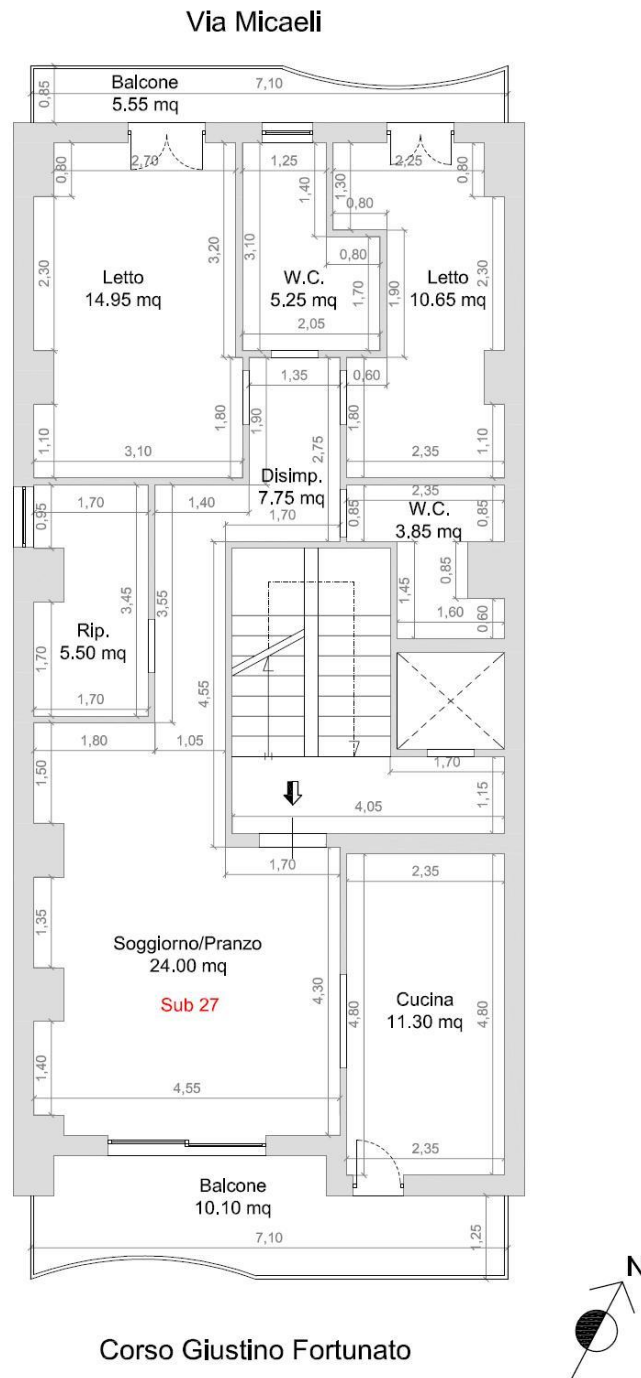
Planimetria Catastale Abitazione Piano Secondo.
